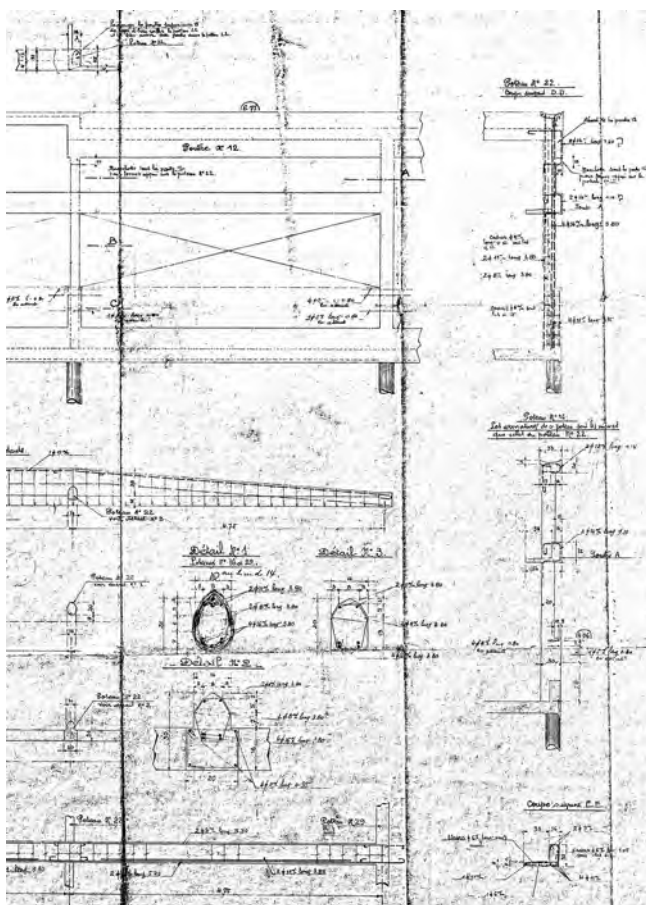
Detalle y correcciones a mano del plano de estructura de la fachada suroeste de la *Villa Savoye* (FLC-H1-13-310). Fuente: Fondation Le Corbusier.
